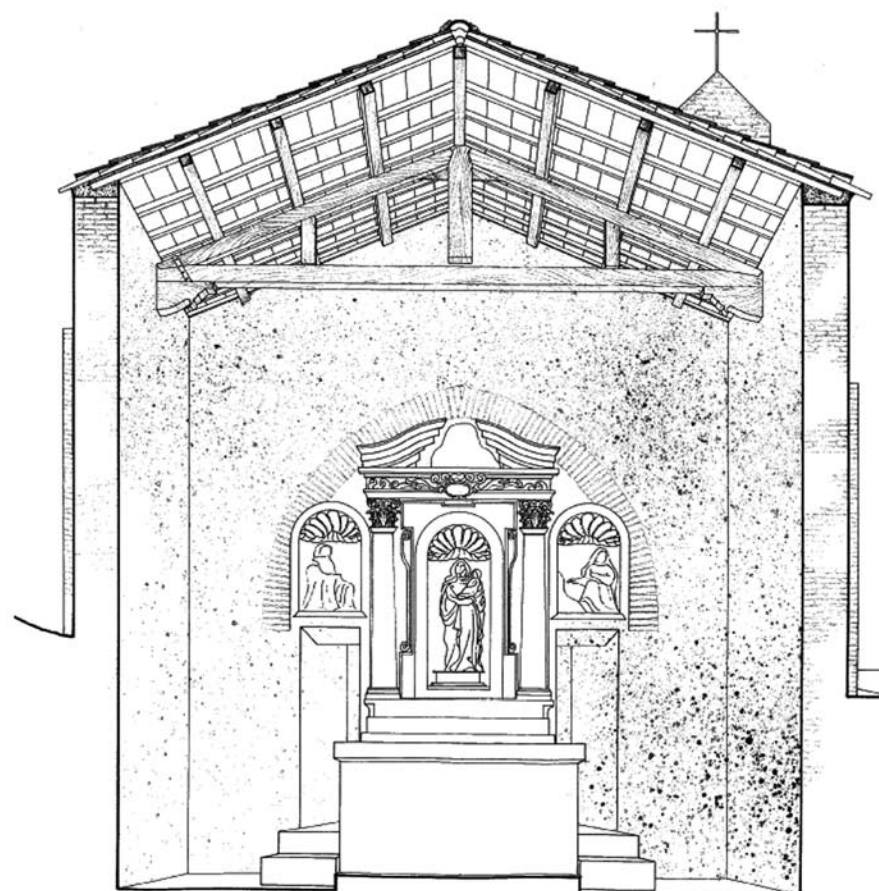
sezione trasversale prospettica 0 1 2 3m
